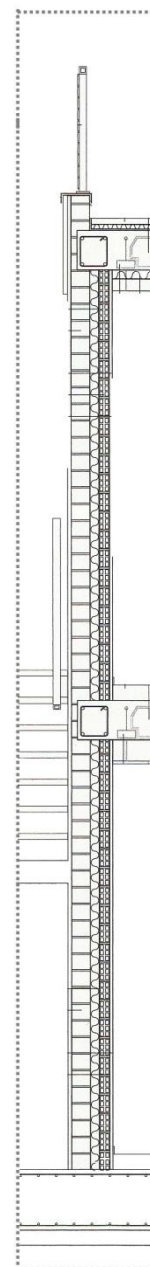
Detalle constructivo de fachada. Fuente (Reyes, Baraona y Pirillo 2007)
